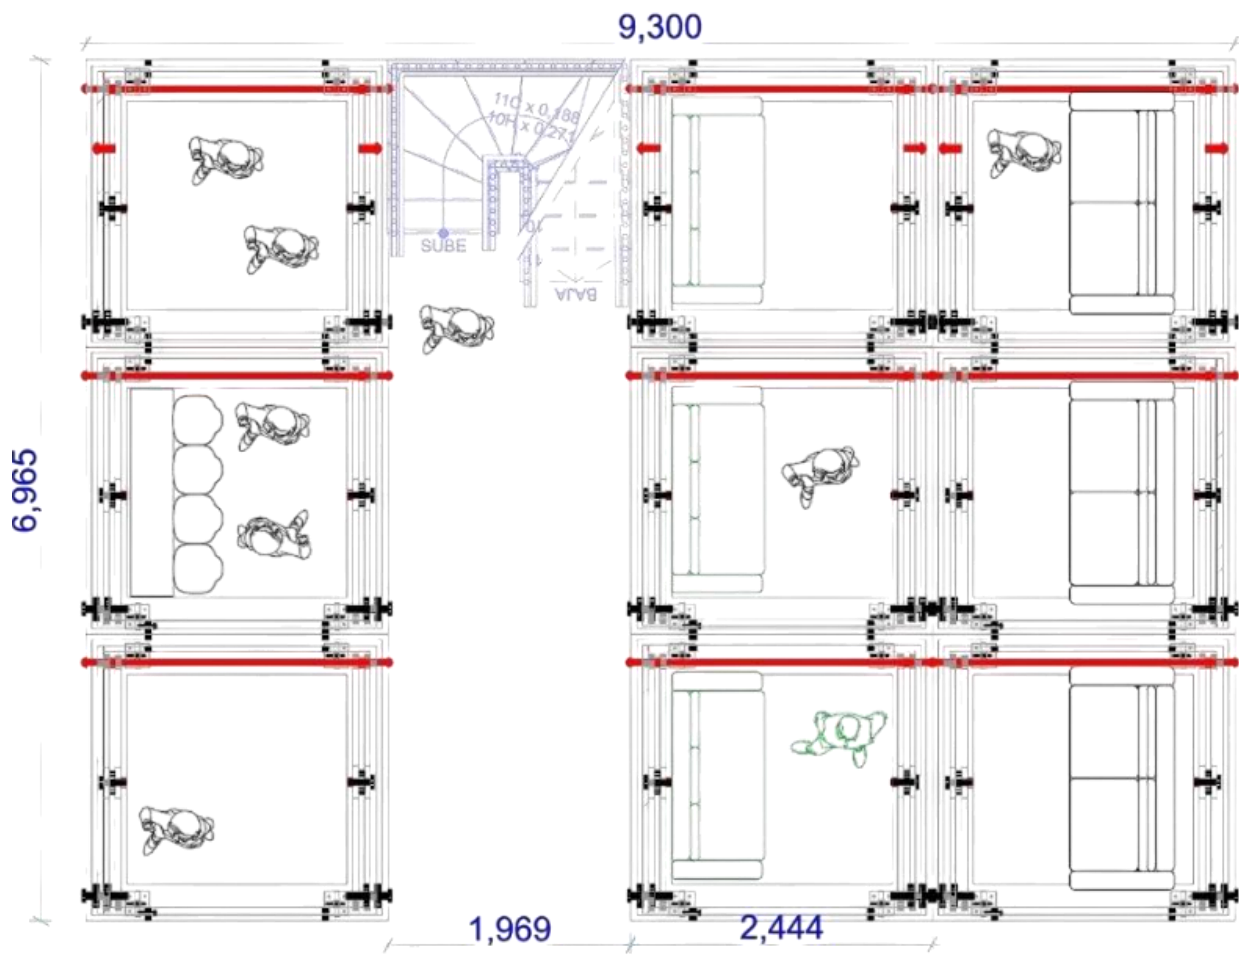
Planta primer nivel propuesta configuración de módulos para camerinos.
